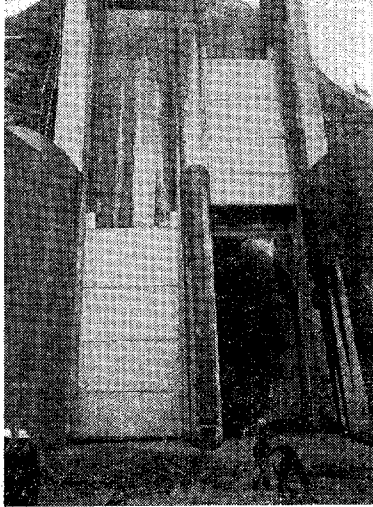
トンネル余水吐（呑口より立体曲線部を望む）
